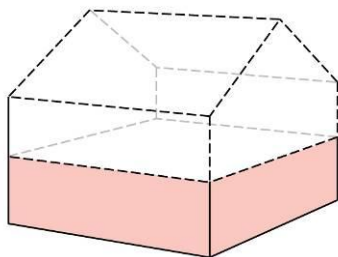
Teilersatzbau. Das oberste Geschoss und das Dach (gleiches Ausmass) werden ersetzt.
